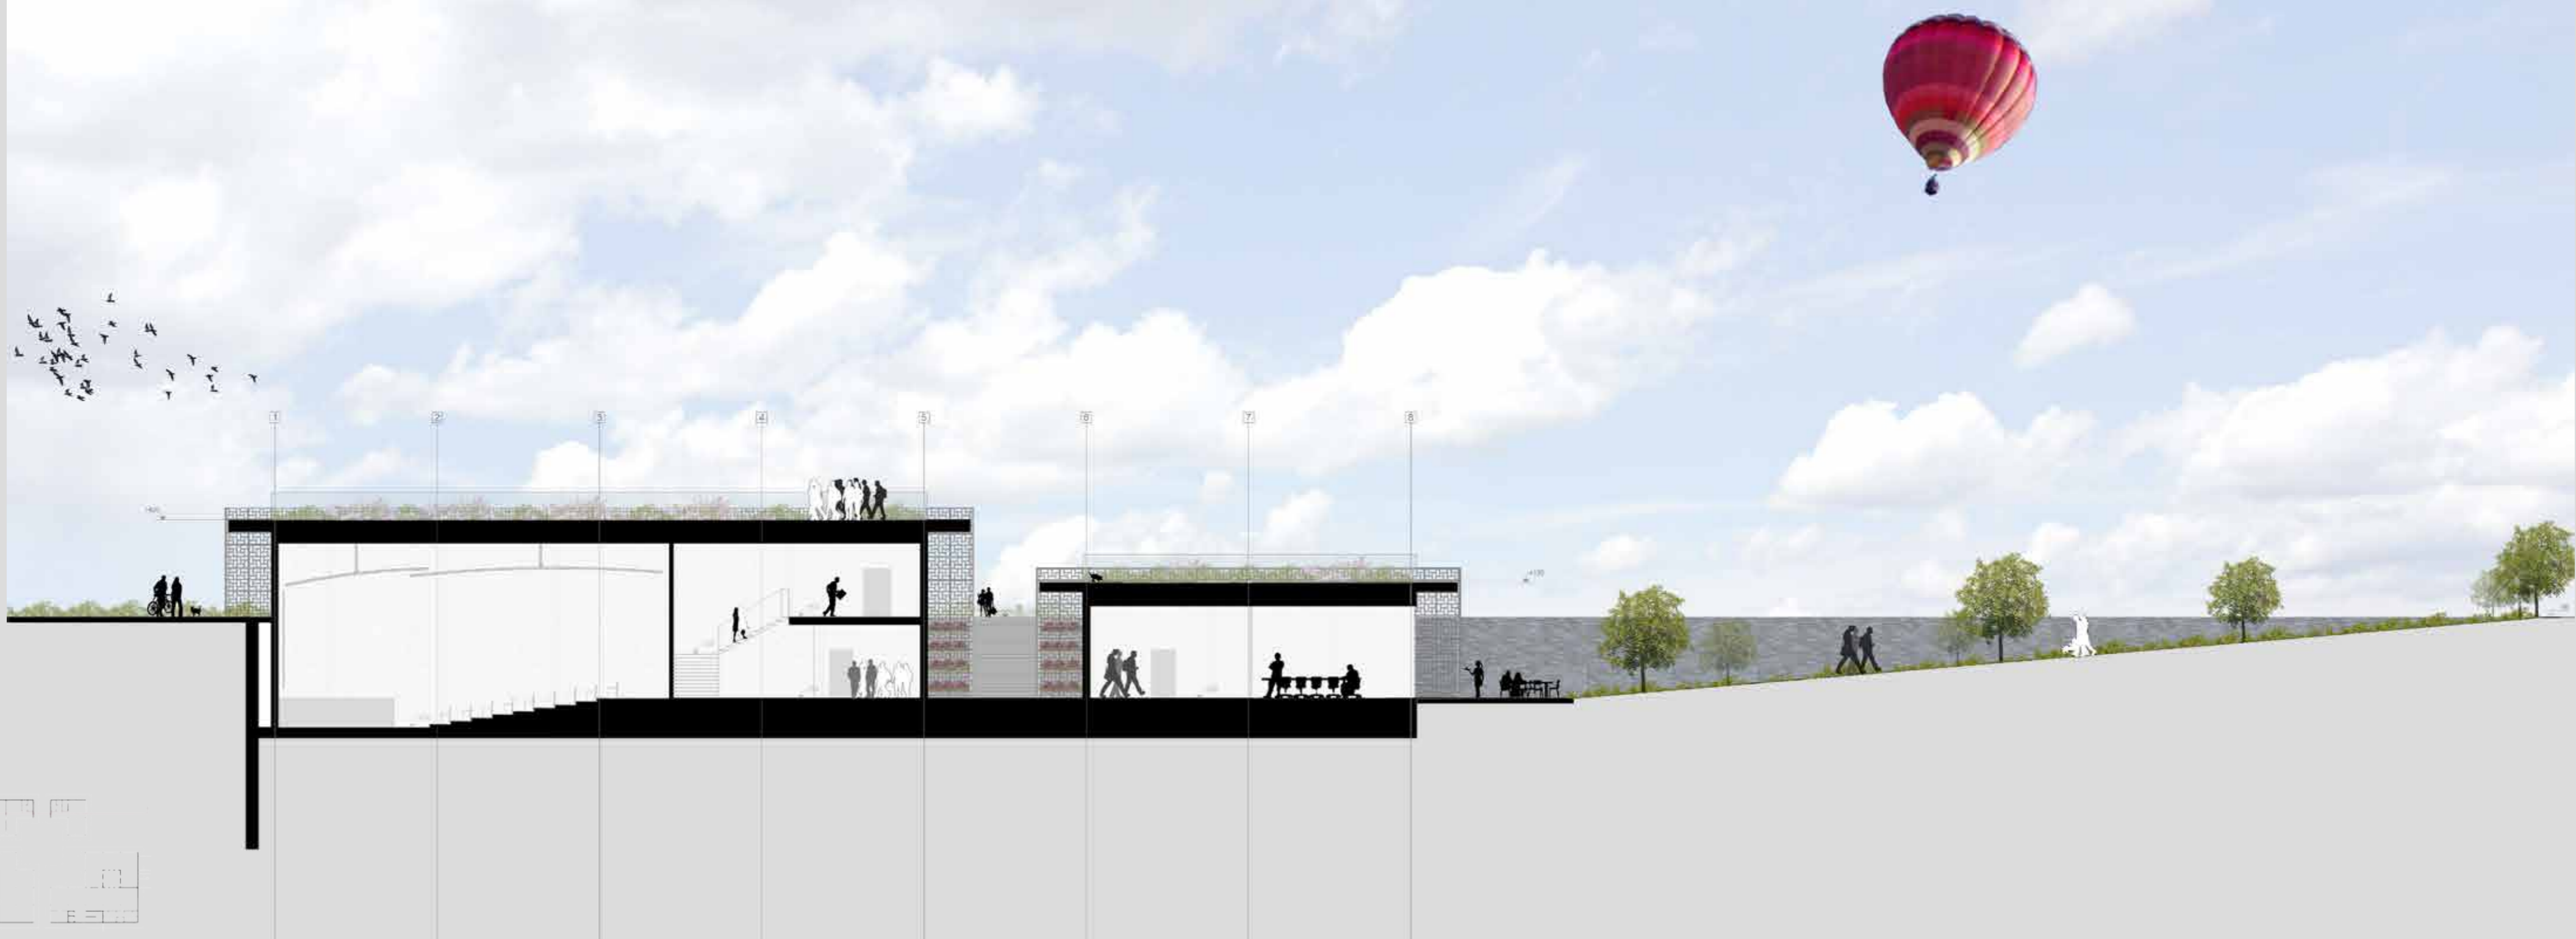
Sezione verticale B-B - Scala: 1:200
